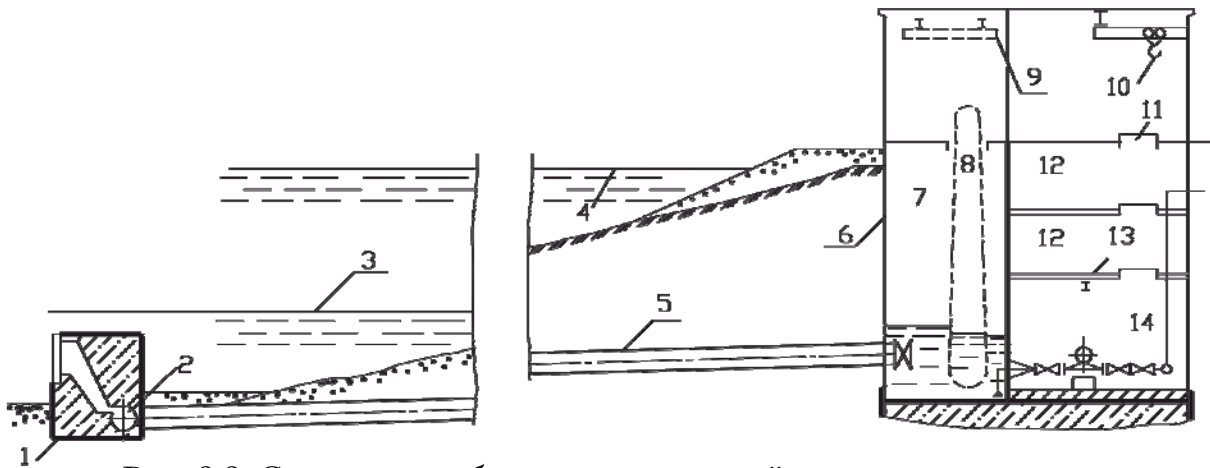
Схема водозаборных сооружений совмещенного типа с русловым затопленным водоприемником:
